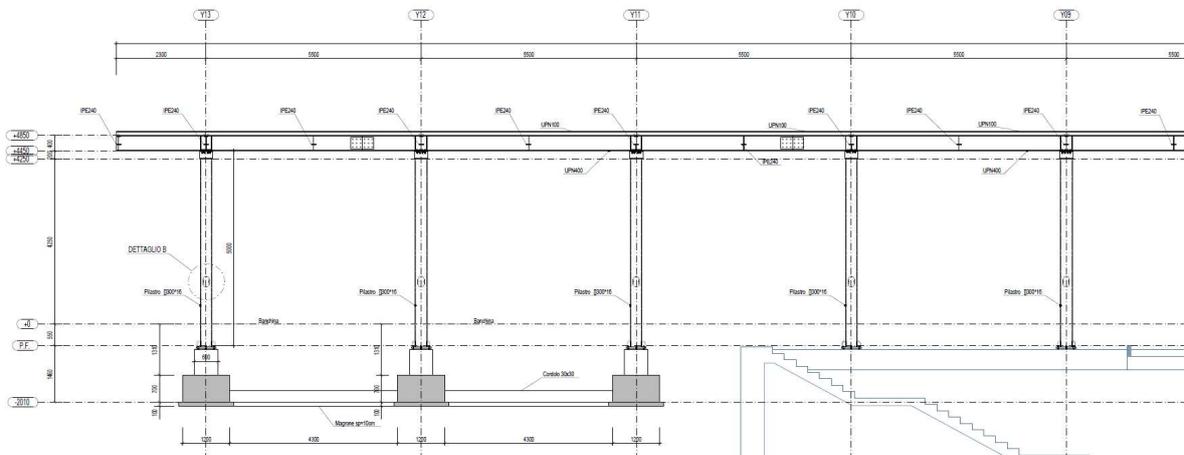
Pensiline – Stralcio sezione longitudinale Pensilina Sud
